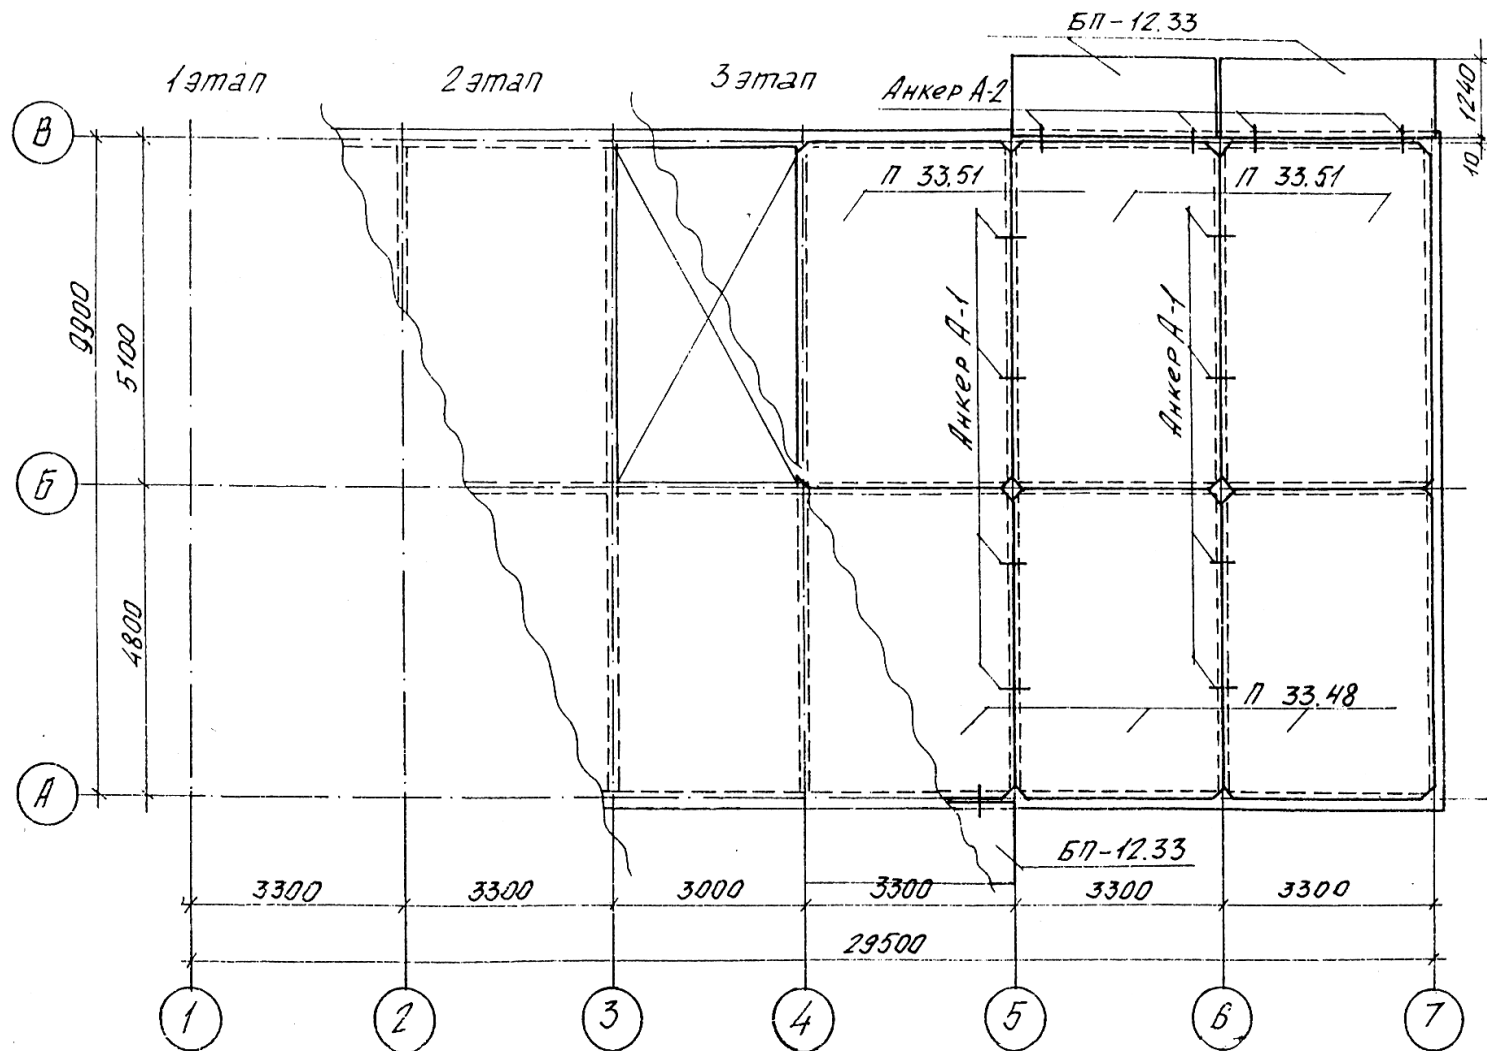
Этапы выполнения плана перекрытия жилого дома
